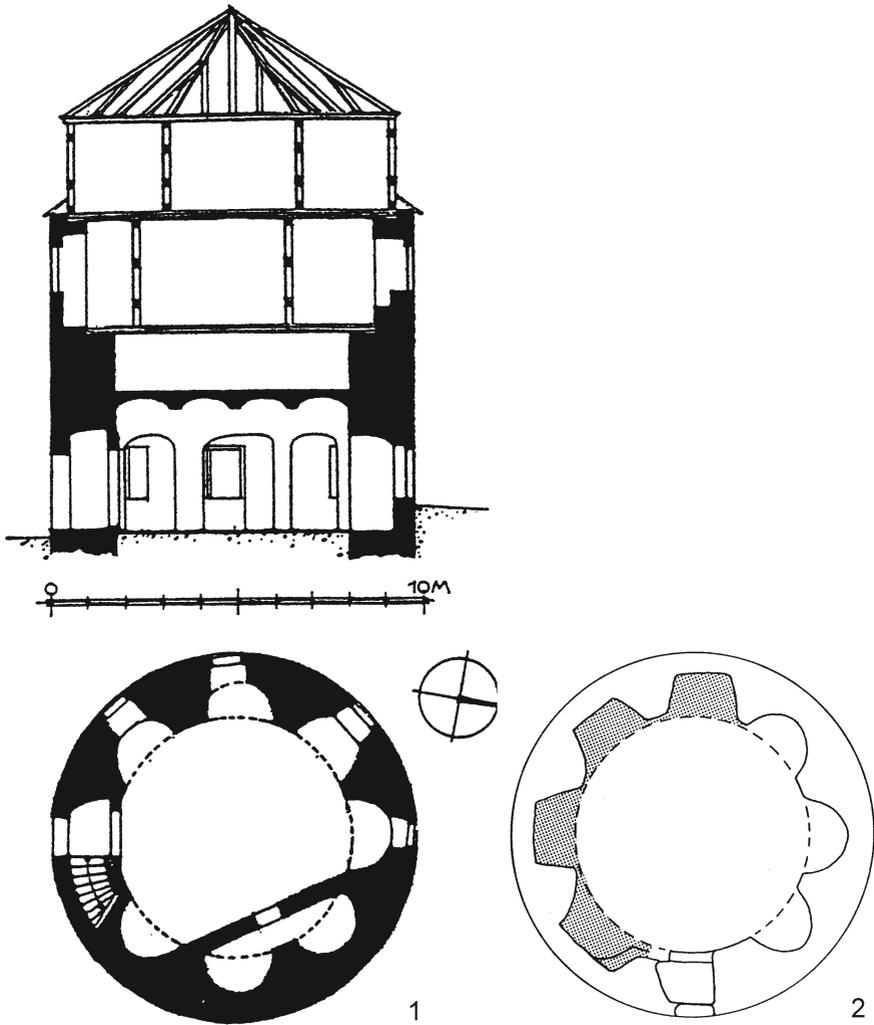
Ludwigsstadt, Lkr. Kronach. 1 Grund- und Aufriss (nach Breuer 1964, 186); 2 Grundriss nach den archäologischen und bauhistorischen Untersuchungen (nach Haberstroh 1989, 195 Abb. 1).
